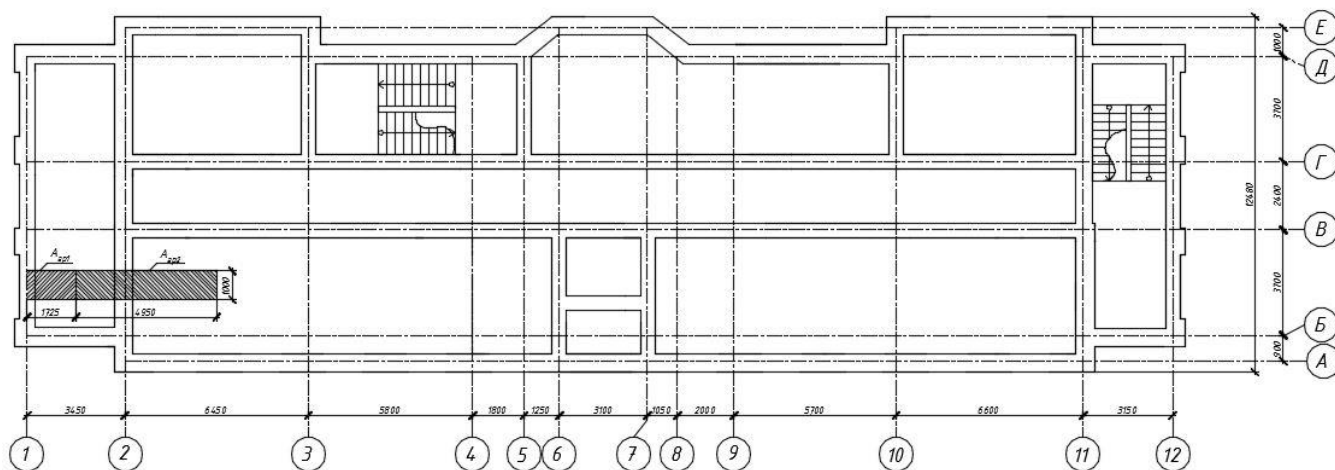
Грузовые площади на фундаменты, расположенные в осях 1/Б-В и 2/Б-В
